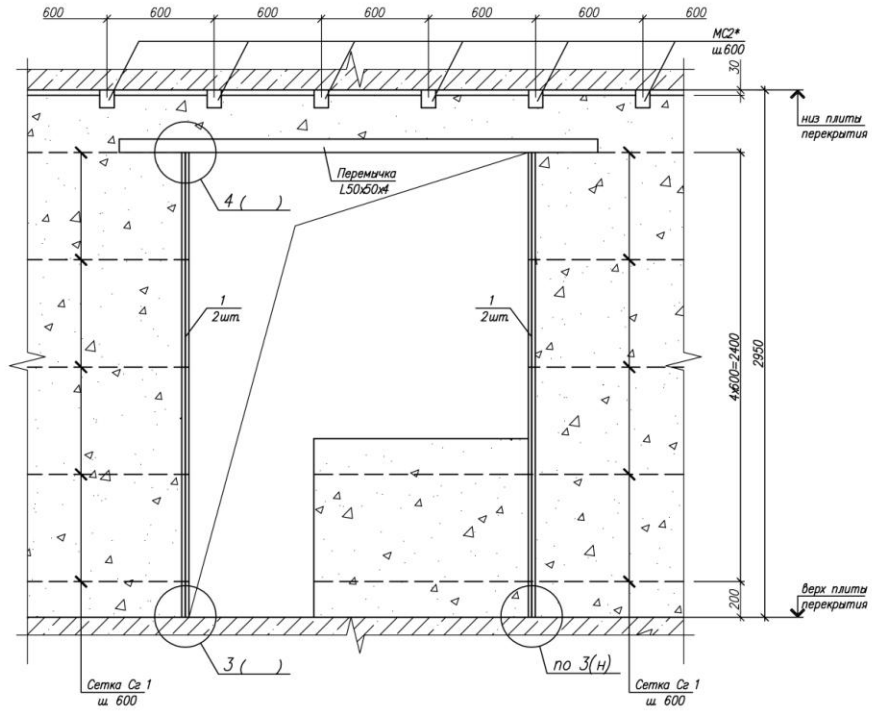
Схема устройства проемов в кладке наружных стен из керамзитобетонных блоков
